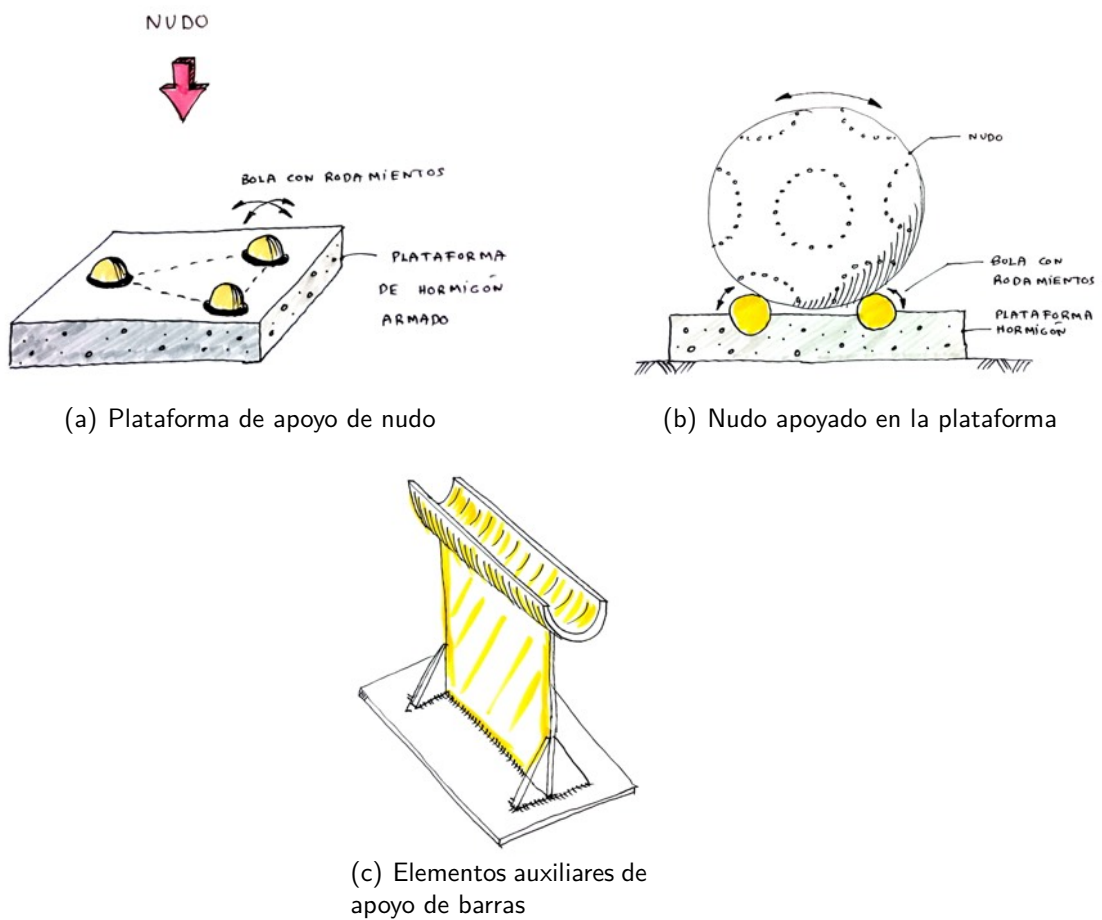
Elementos auxiliares a construir previos al montaje de la estructura
